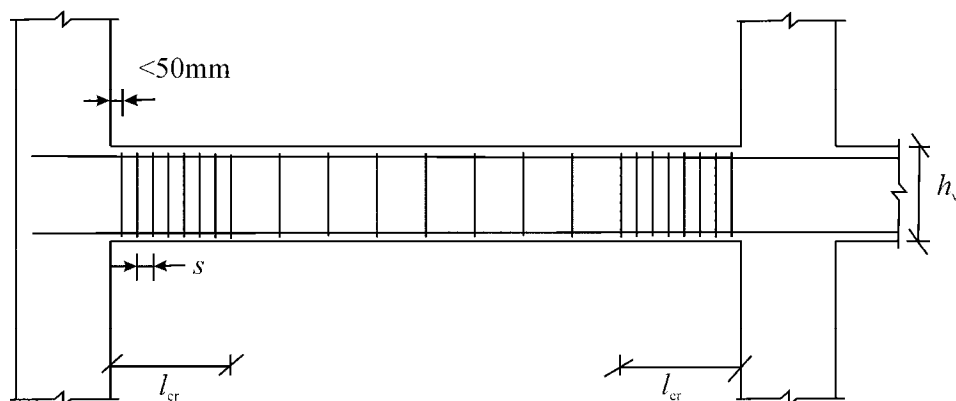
Armaduras transversais nas zonas críticas das vigas
